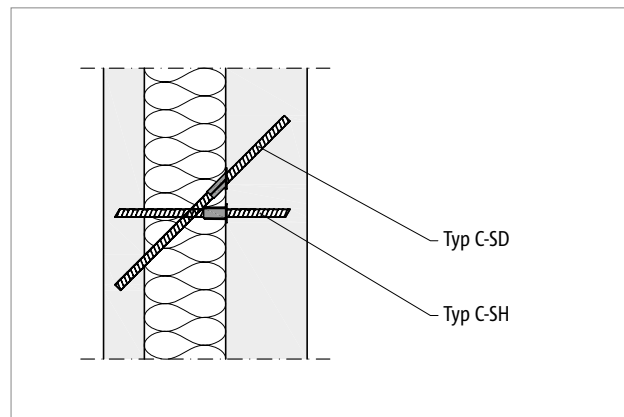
Schöck Isolink® Typ C-SH, C-SD: Sandwichwand
